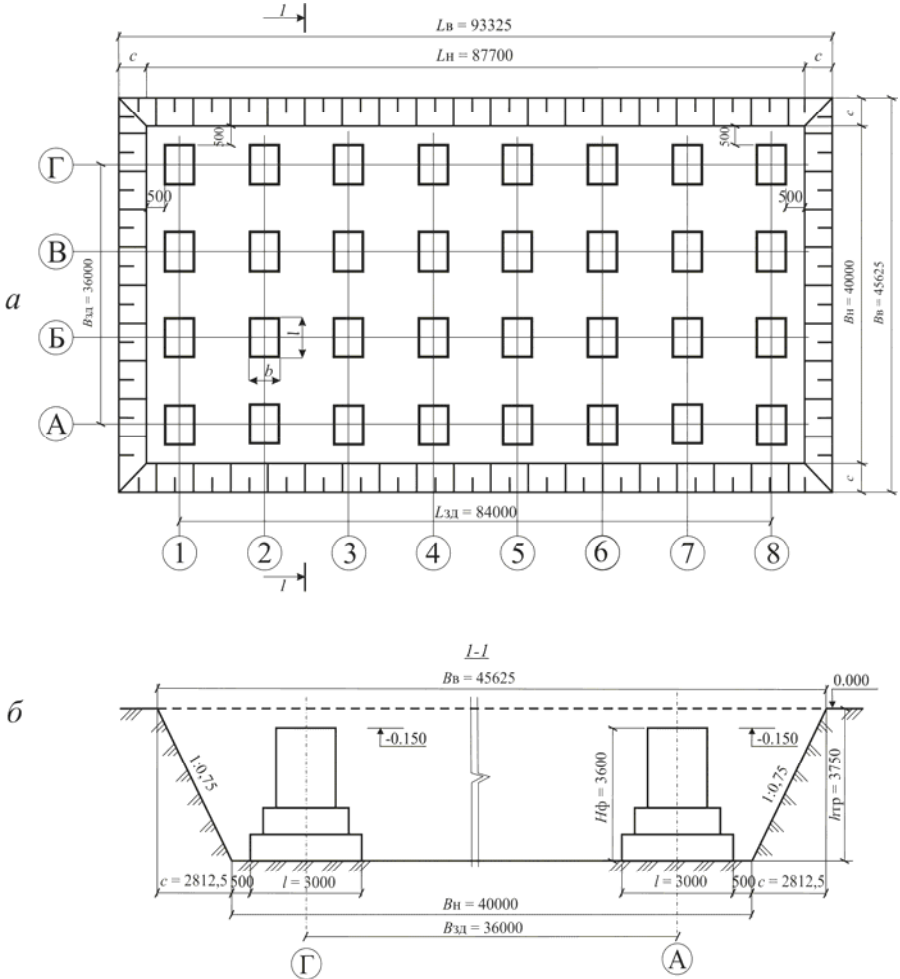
Общий вид котлована для возведения фундаментов:
